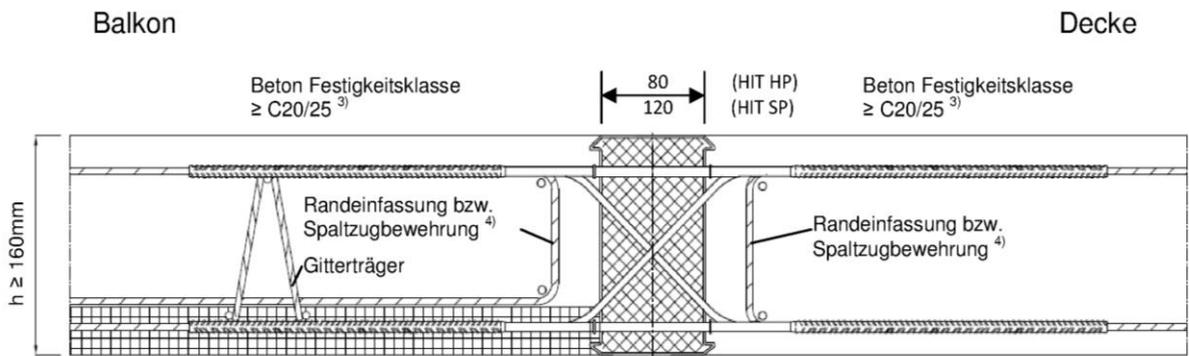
Beispiel für den Anschluss HIT-HP/SP DD mit Elementplatte mit statisch - wirksamer Ortbetonschicht
